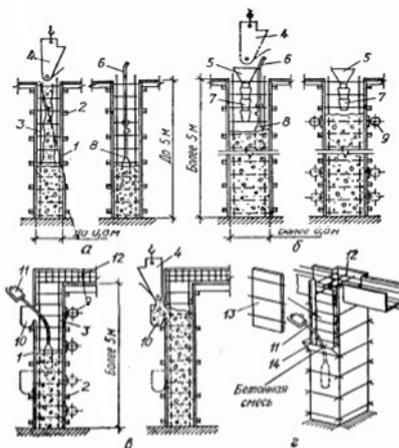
Схемы бетонирования колонн: а — бетонирование колонн высотой до 5 м; б — то же, при высоте более 5 м; в, г — то же, с густой арматурой балок; 1 — опалубка; 2 — хомуты; 3 —
